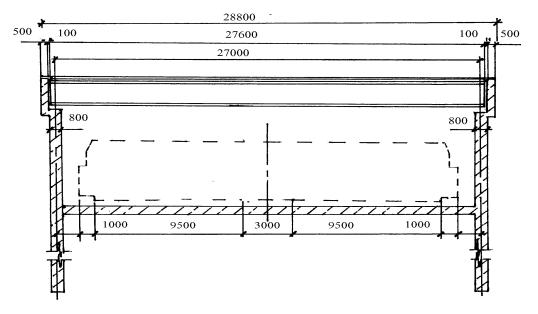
Схема однопролетного путепровода тоннельного типа с металлическими балками пролетного строения пролетом 27,5 м
